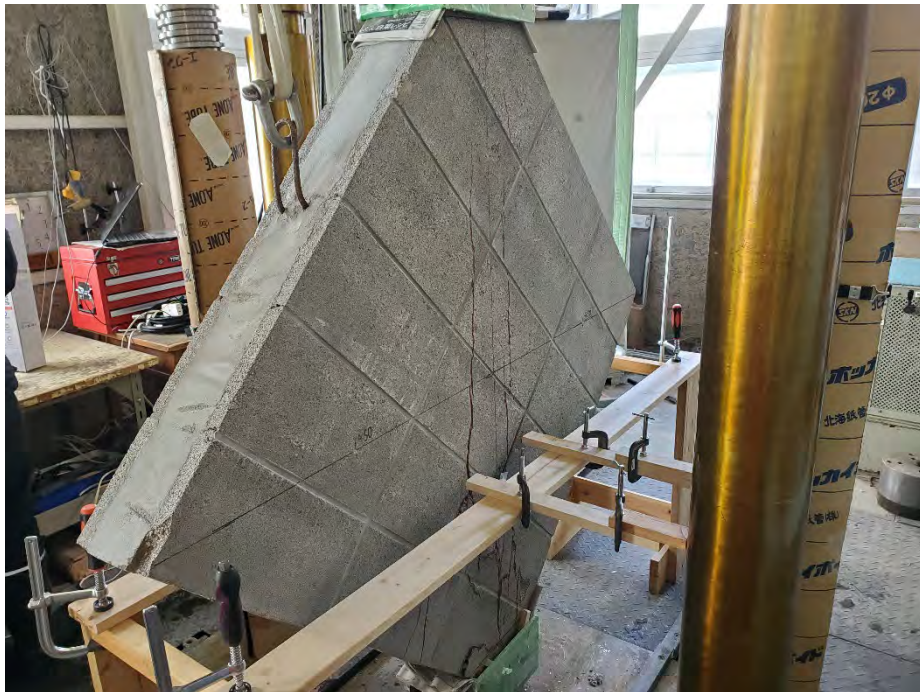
(2)-2 試験体 B の破壊状況(4):裏面
